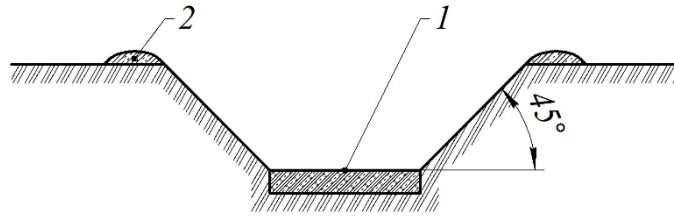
Розробка котлована під фундамент в глинистому ґрунті:
